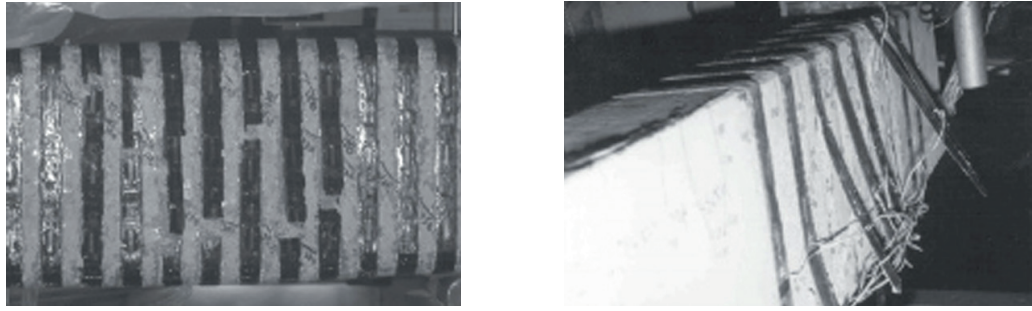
Colapso de vigas por ruptura e por descolamento do PRFC.
